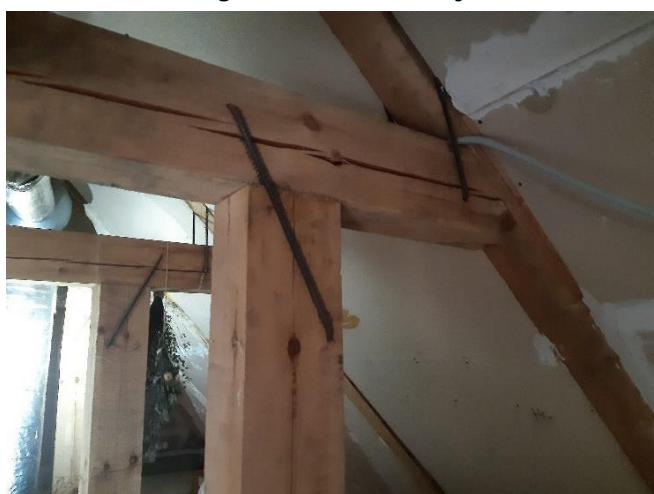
mainītās un protezētās jumta konstrukcijas
